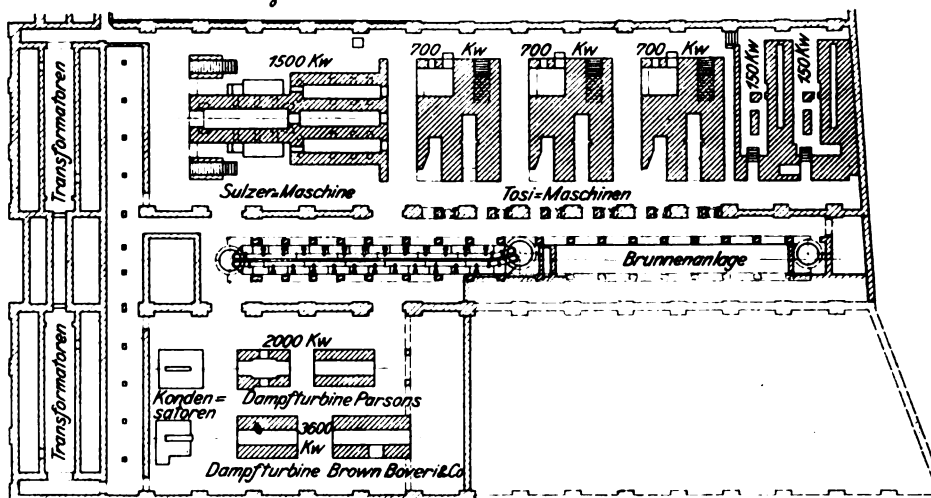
Grundriss des Kraftwerkes Porta Volta.
